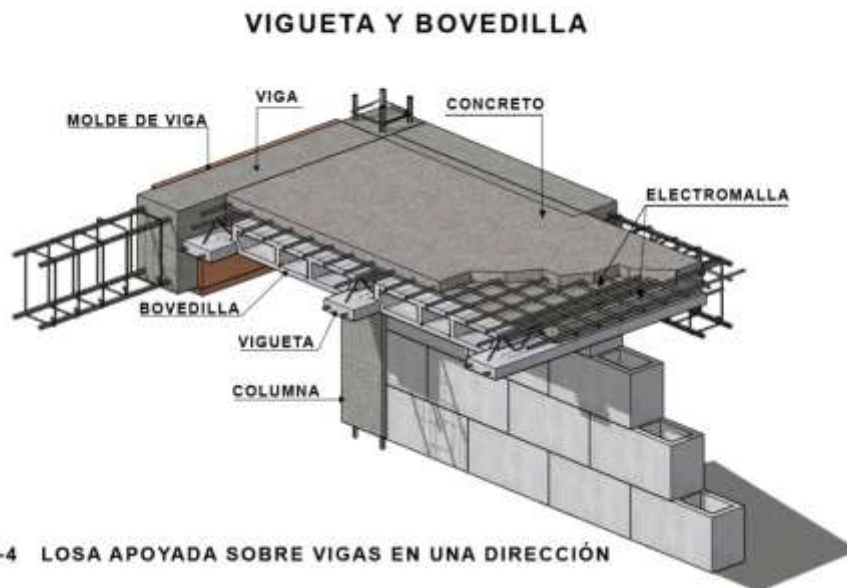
LOSA APOYADA SOBRE VIGAS EN UNA DIRECCIÓN
